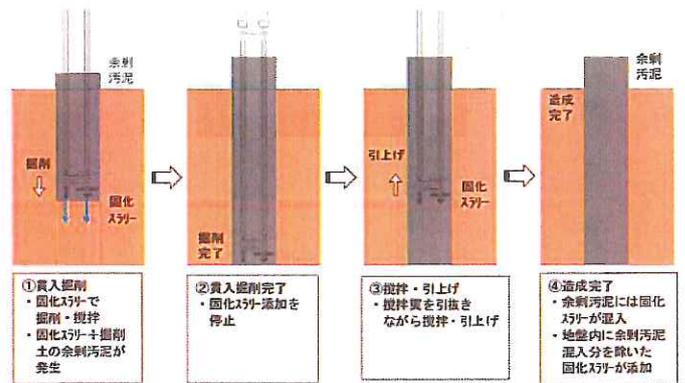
従来の地盤改良工法の施工手順⁴⁾
